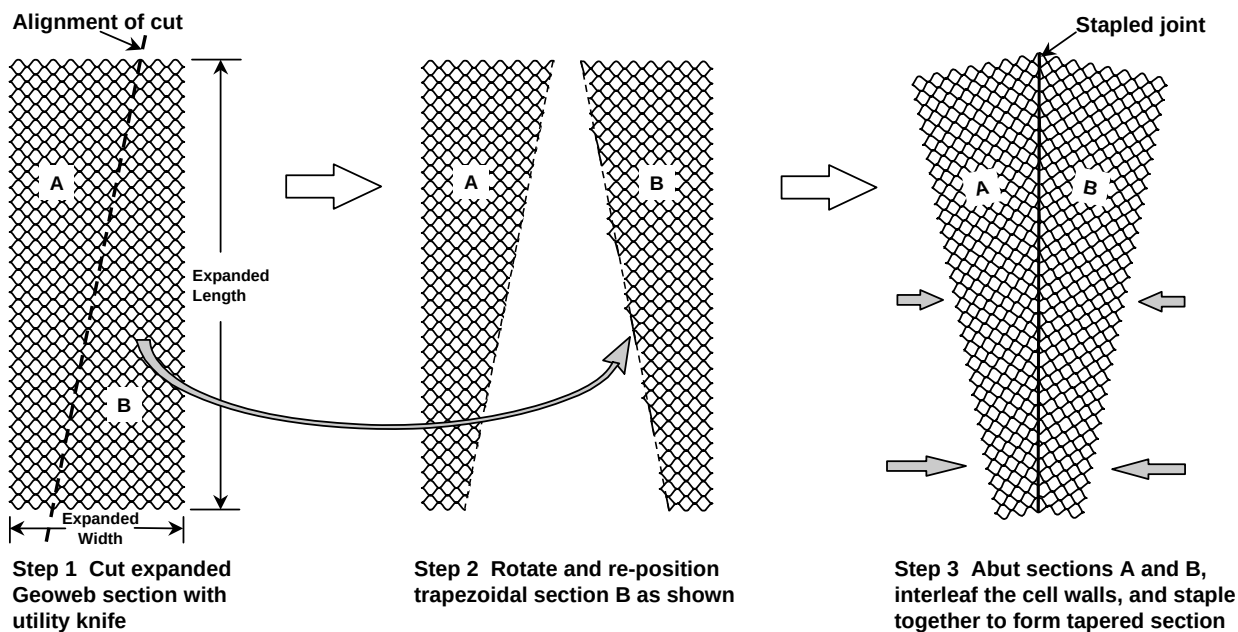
Corte en Obra de una Sección Geoweb® para lograr una Forma Trapezoidal
